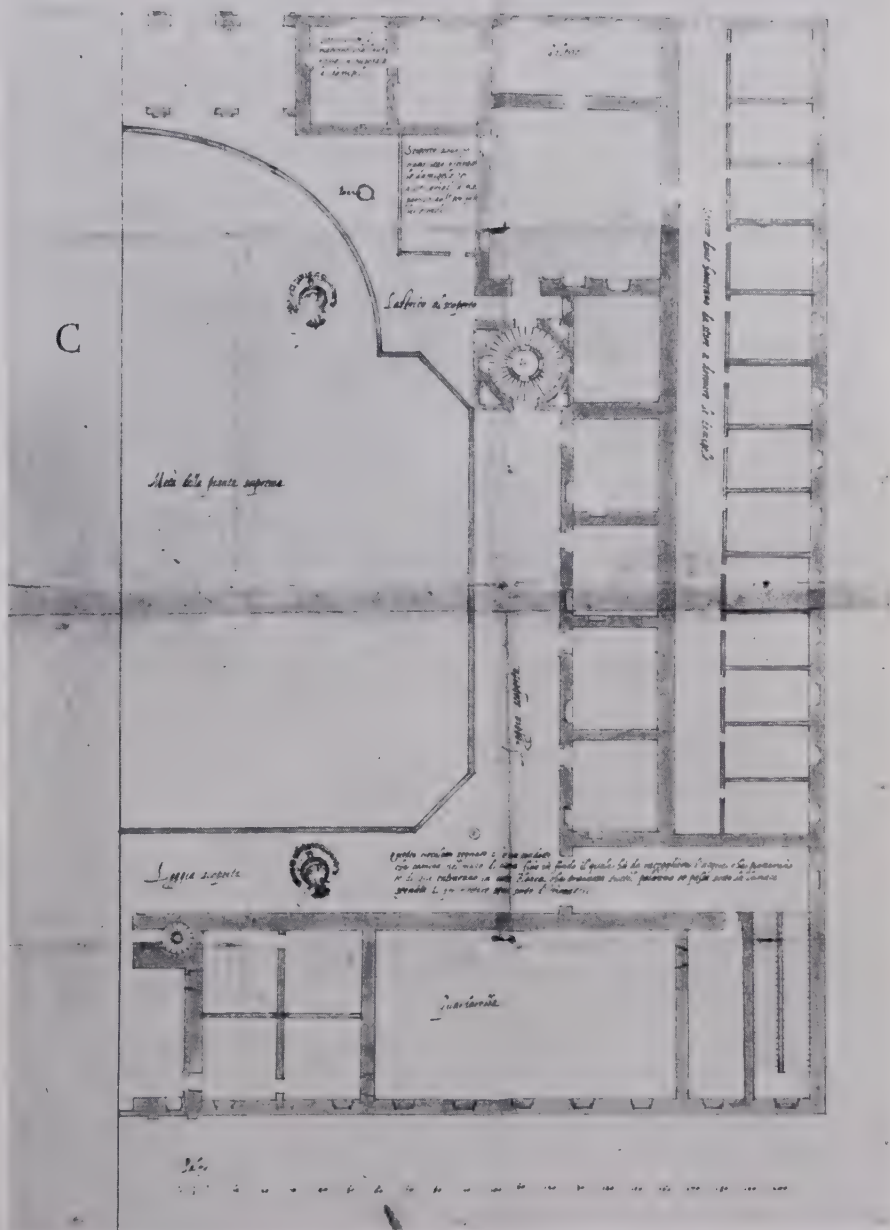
Copia da Vignola: Pianta del terzo piano del palazzo Farnese di Piacenza (A. S. P.)
